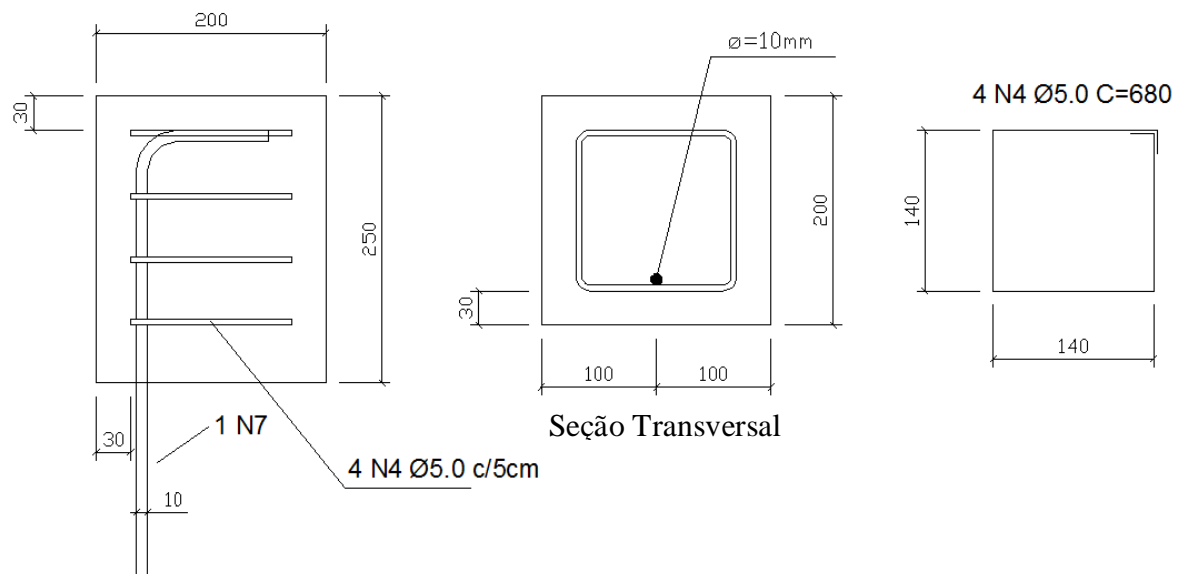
Detalhe do modelo de arrancamento com barras retas de 10 mm com estribos (dimensões em mm)
